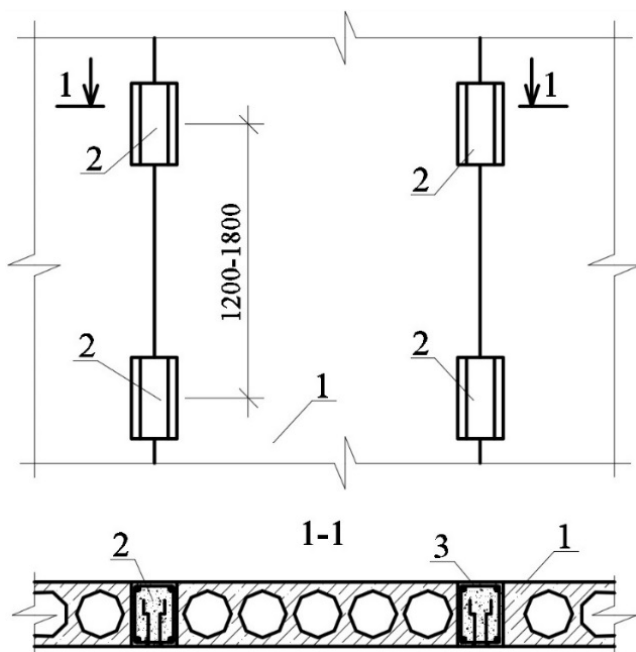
Фрагмент монтажного плана сборных плит перекрытия:
